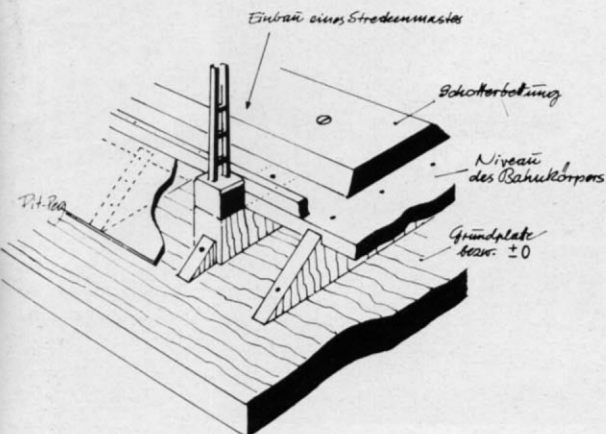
d. Betonmastfundament an einem schrägen Damm, nebst Konstruktionsdetails von Pit-Peg skizziert.
